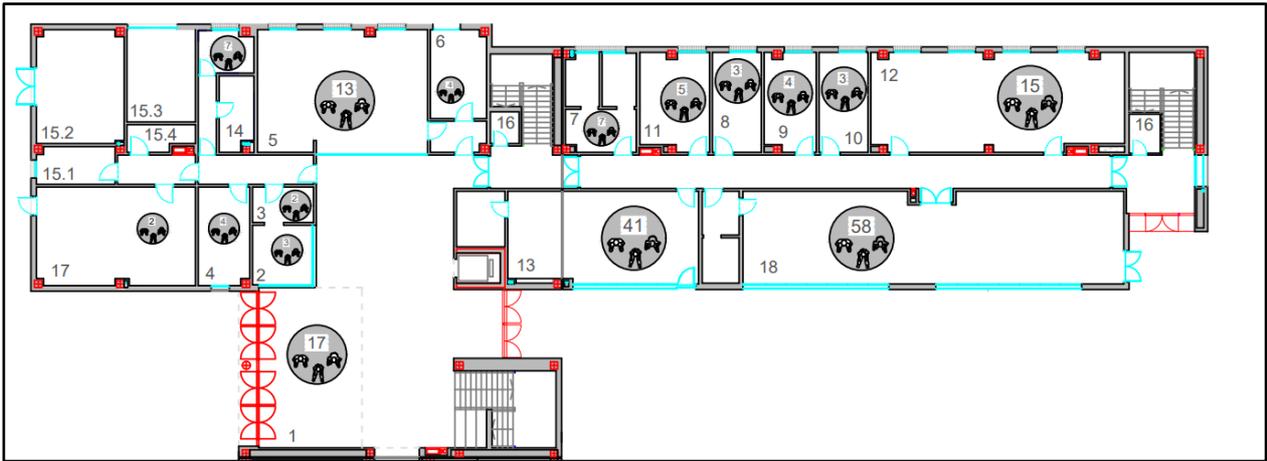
Plano con ocupación por aula de la planta baja - mitad superior
